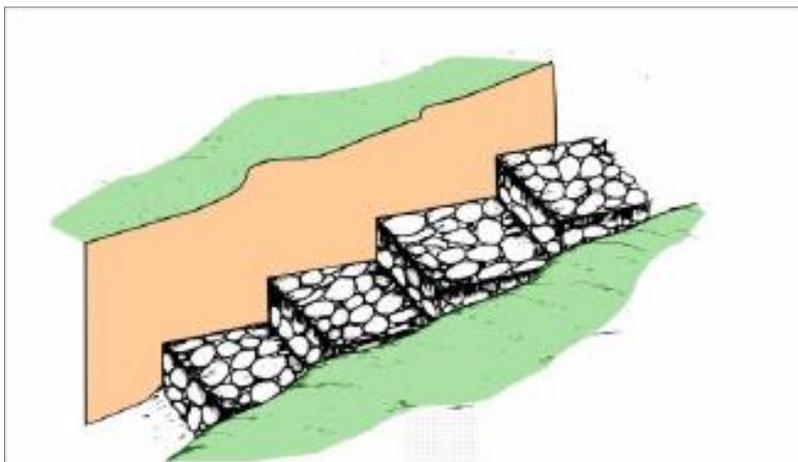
Protección del lecho de la quebrada con muros escalonados (andenes), utilizando bloques de roca o concreto armado.
